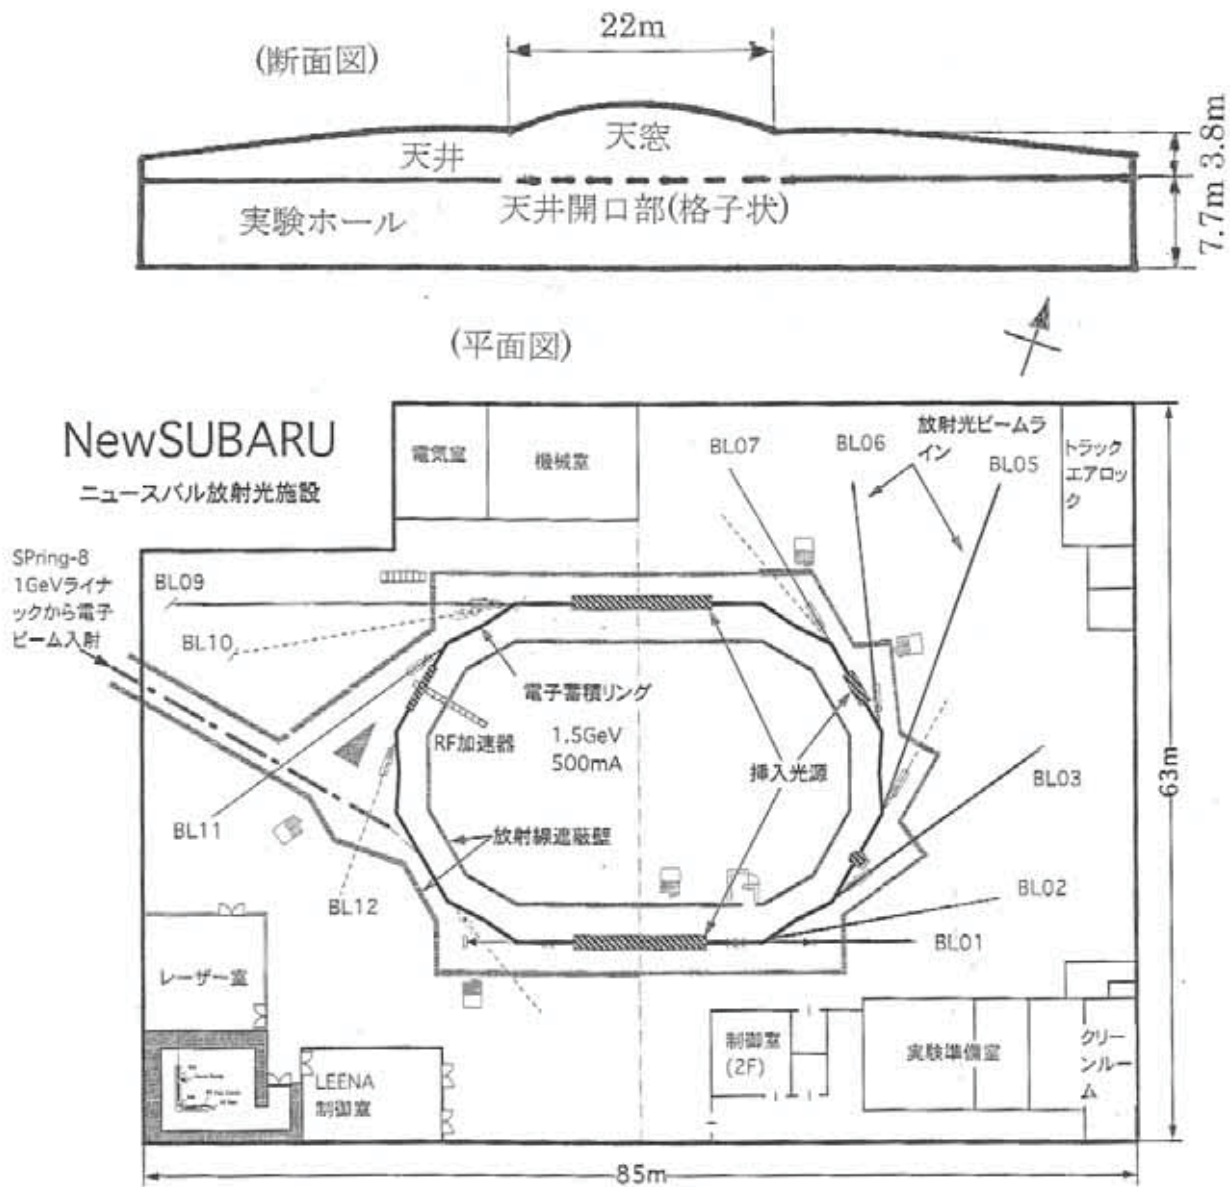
ニュースバル実験施設実験棟の平面図と断面図(平面図はNS 施設提供).
